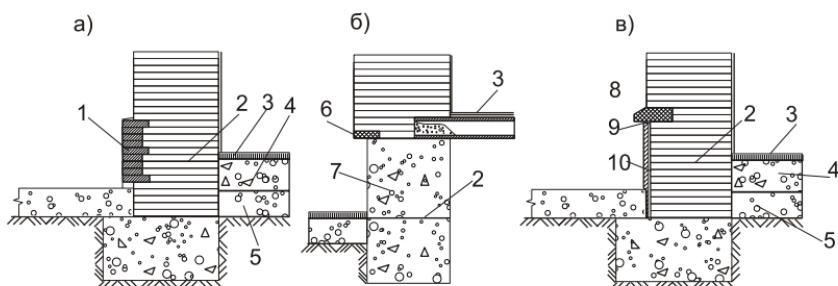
Цоколи кирпичных стен: а — облицованный отборным кирпичом; б — из бетонных блоков; в — облицованный тесаными плитами из естественного камня: 1 — лицевой кирпич; 2 — гидроизоляционный слой; 3 — пол первого этажа; 4 — бетонная подготовка; 5 — уплотненный грунт; 6 — кордон из железобетонных брусков; 7 — стена подвала из бетонных блоков; 8 — кордонный камень; 9 — осадочный зазор; 10 — каменные плиты
